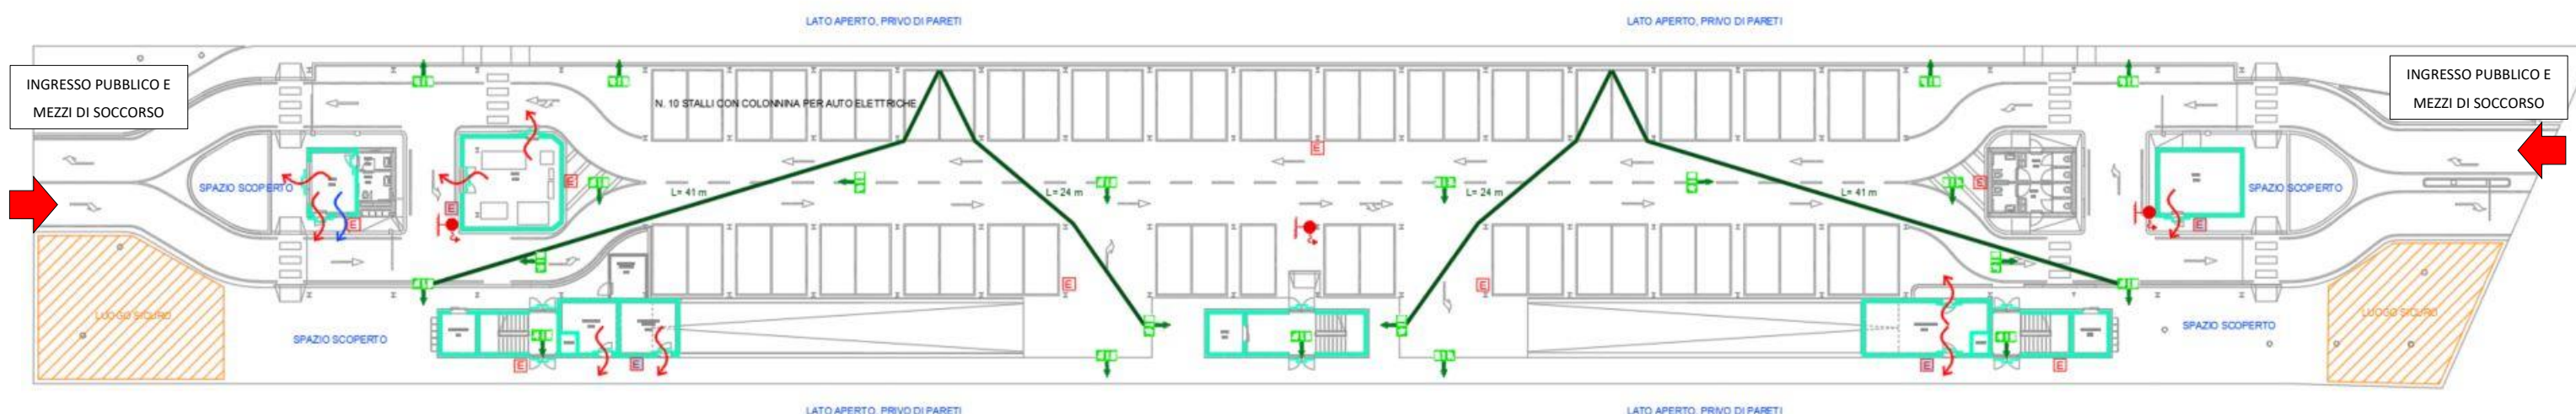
Pianta Piano Terra Parcheggio via Saliceto
